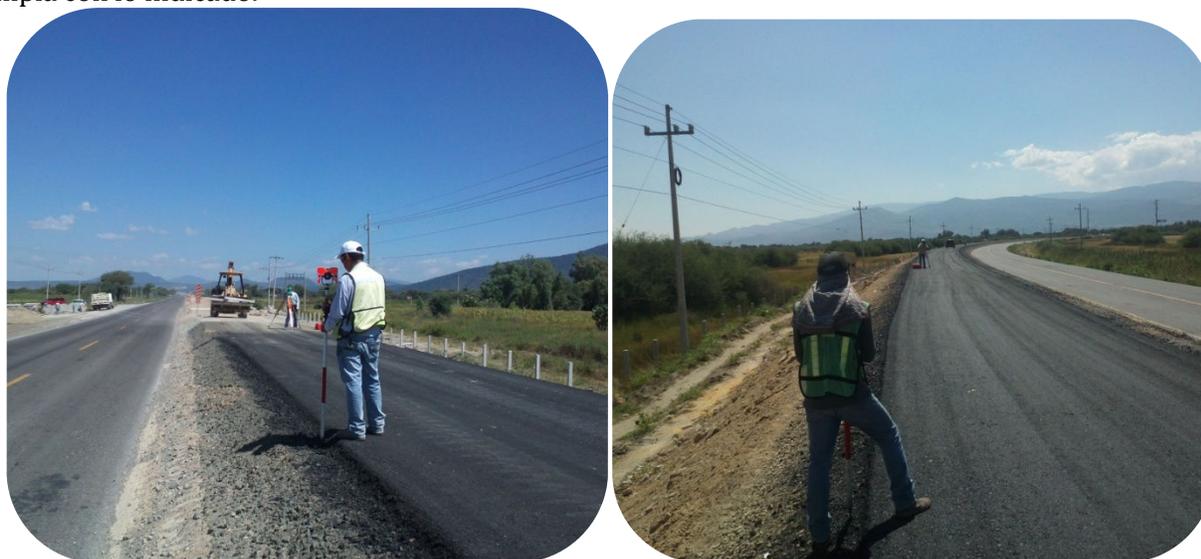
Levantamiento de secciones transversales para tramo terminado de base asfáltica.
